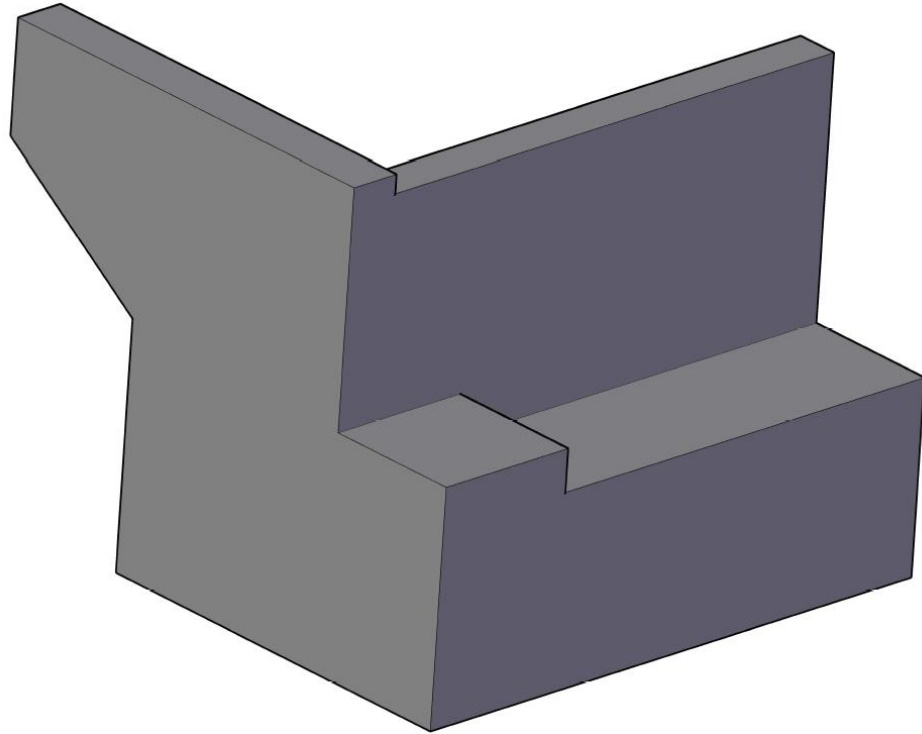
Vista General de Mitad de Estribo Puente Águila Norte.
